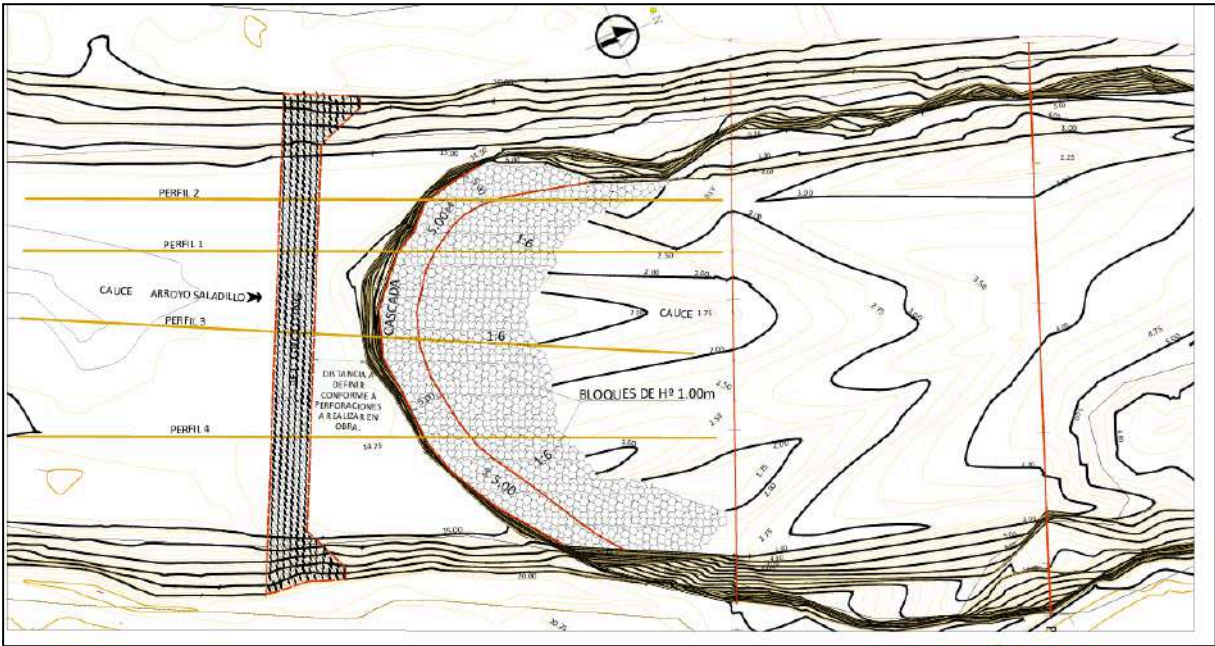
Etapa 1 (2021). Obra provisoria. Bloques de hormigón y jet grouting para un caudal de 550 m³/s.
